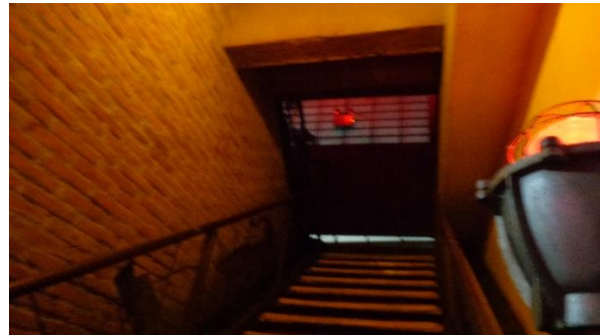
Vista inferior de escalera acceso a segundo piso (cota +0,00 m).
